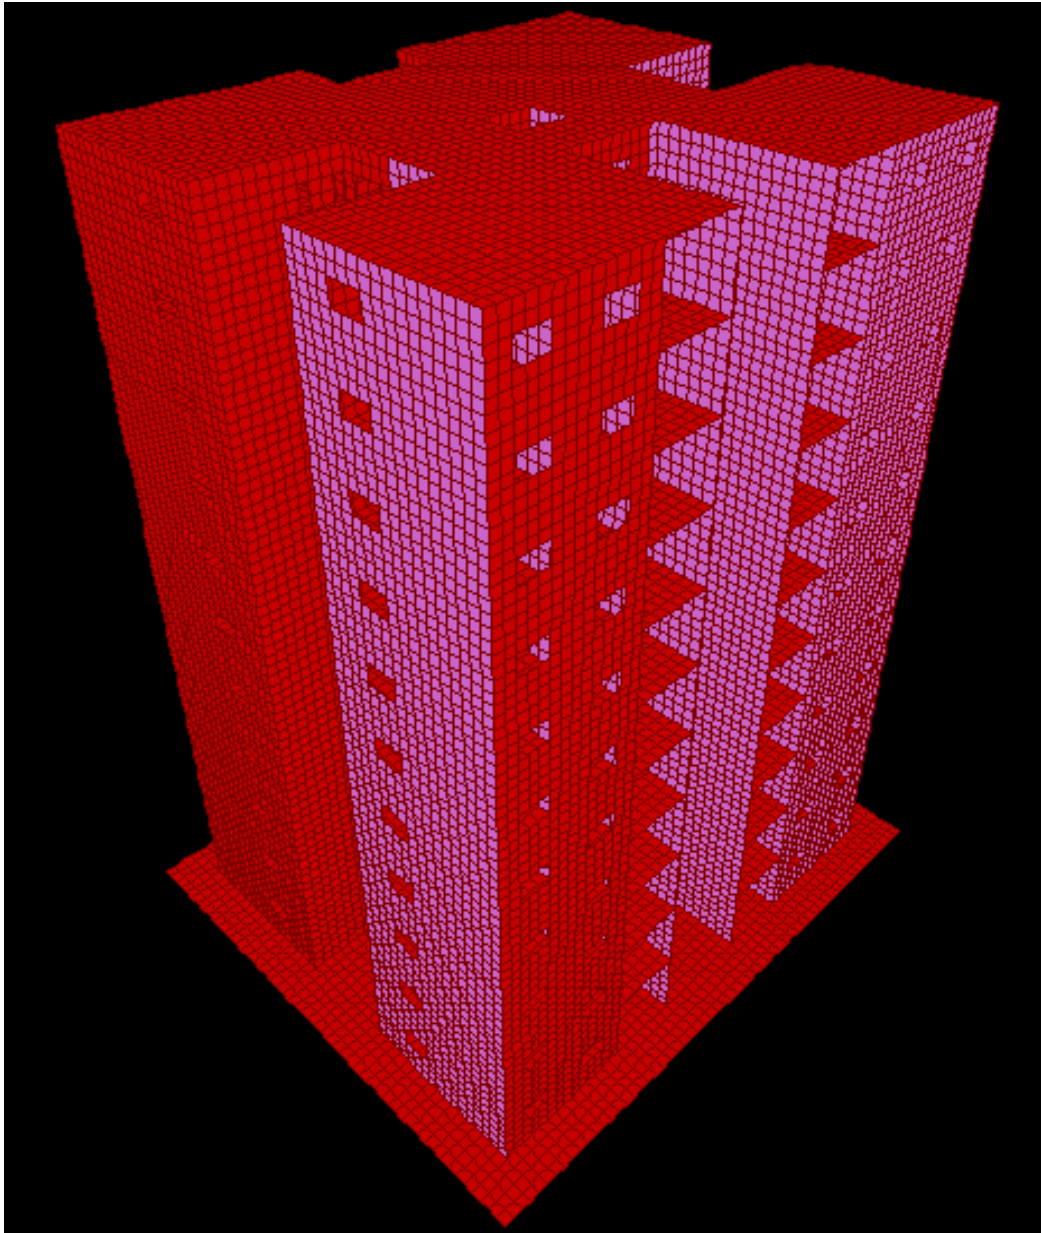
Definição do elemento de fundação (Radier).
